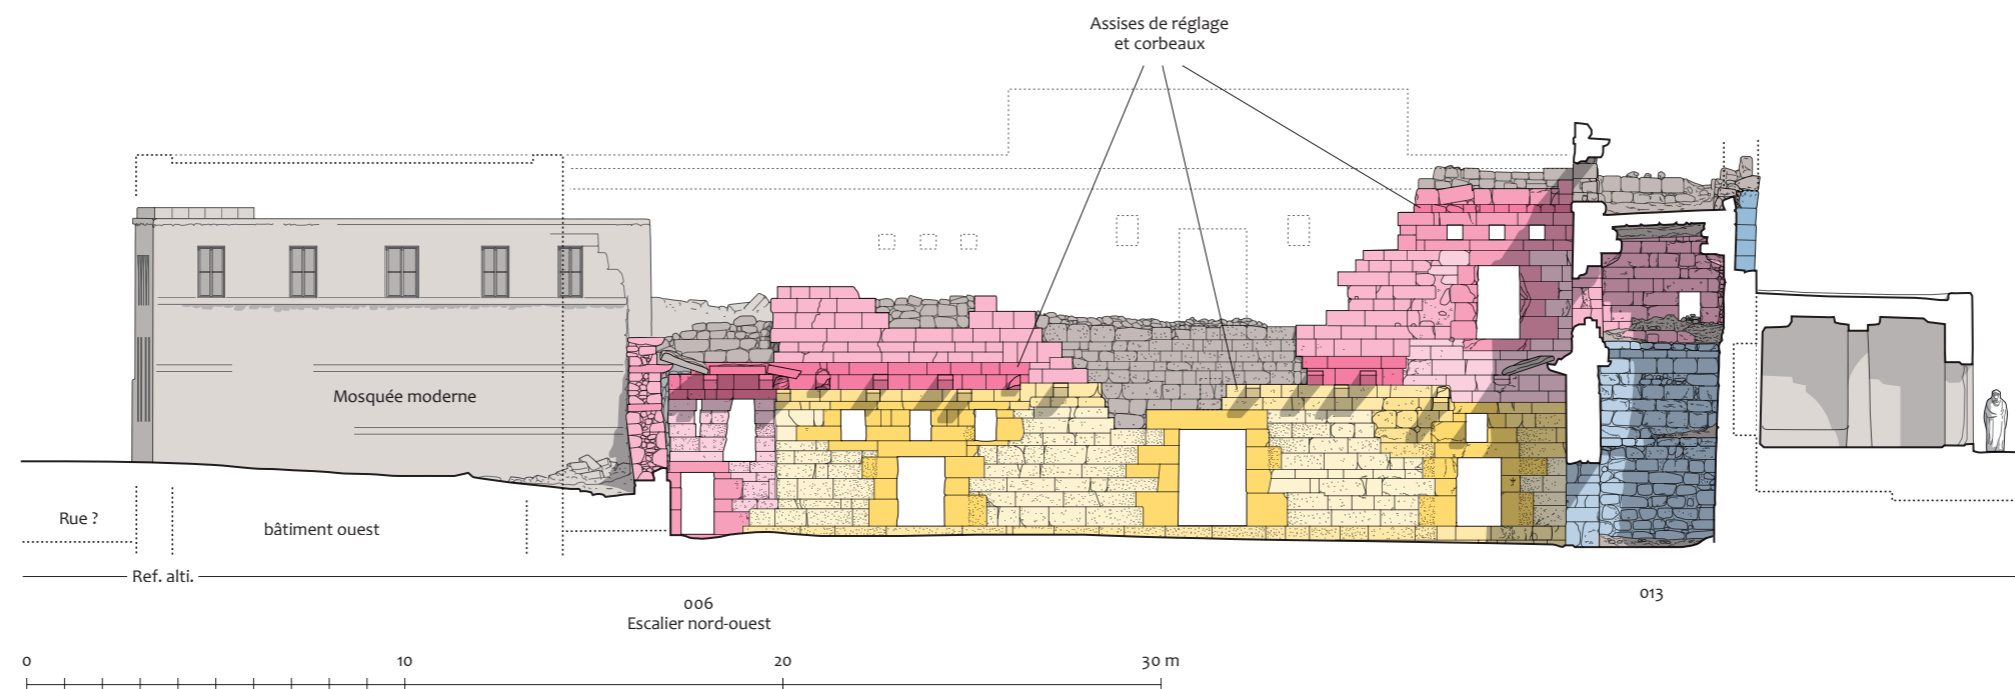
Le « Palais de Trajan », coupe 2, façade nord sur cour.
